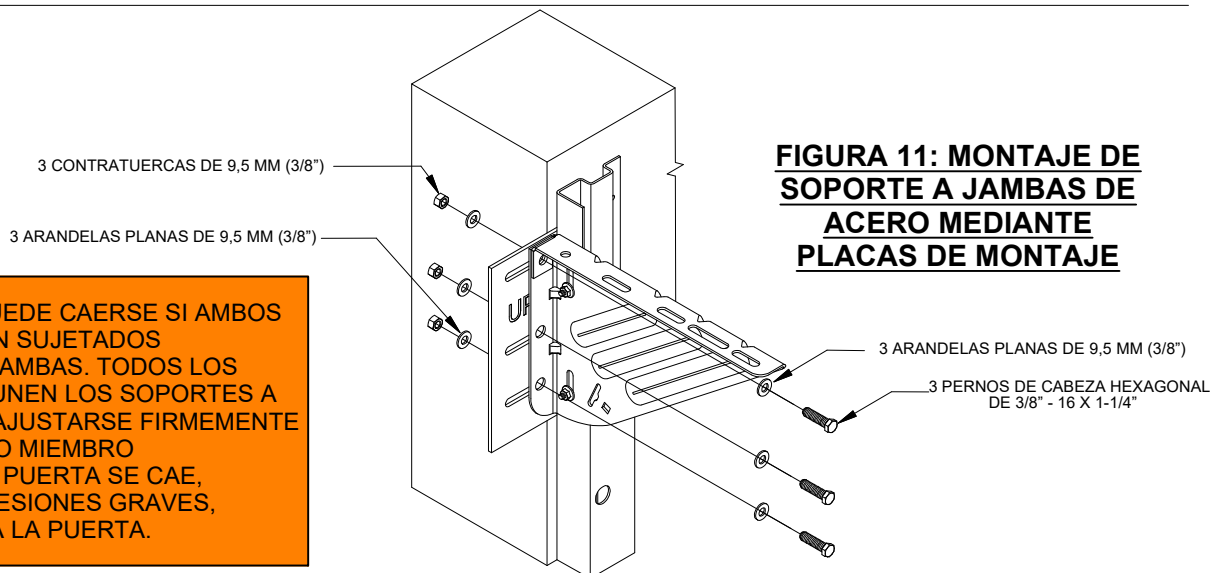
MONTAJE DE SOPORTE A JAMBAS DE ACERO MEDIANTE PLACAS DE MONTAJE
